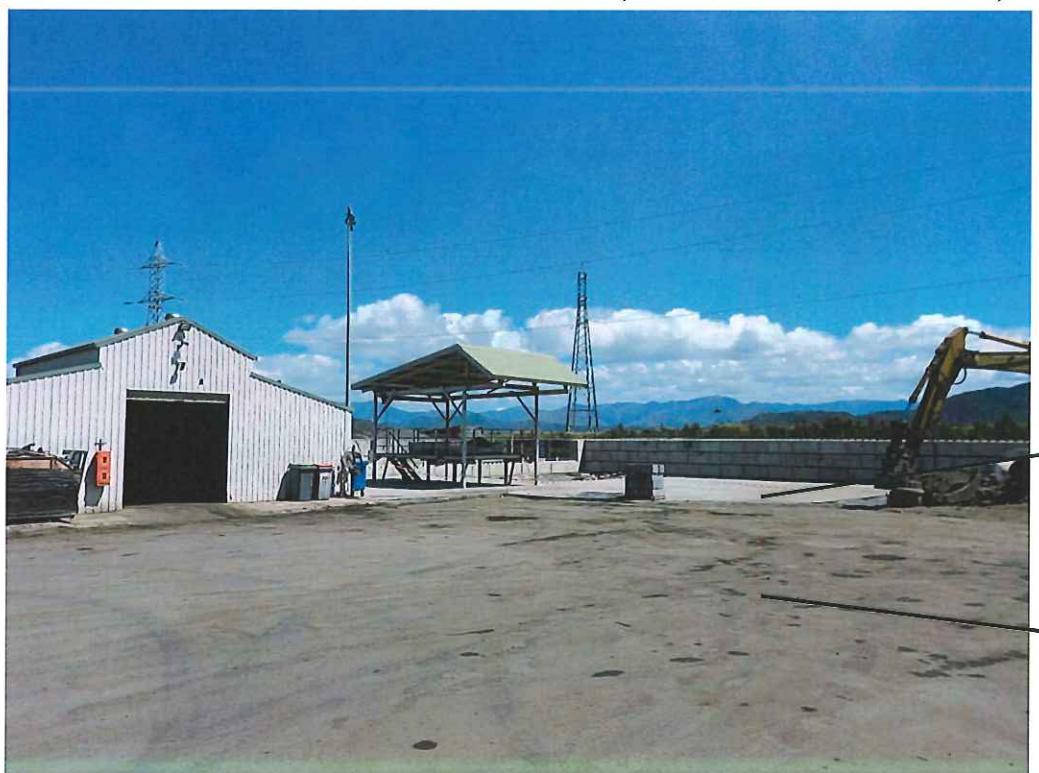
couverture horizontale de la zone de la tranche 1A (vue en direction du Sud-Est)
